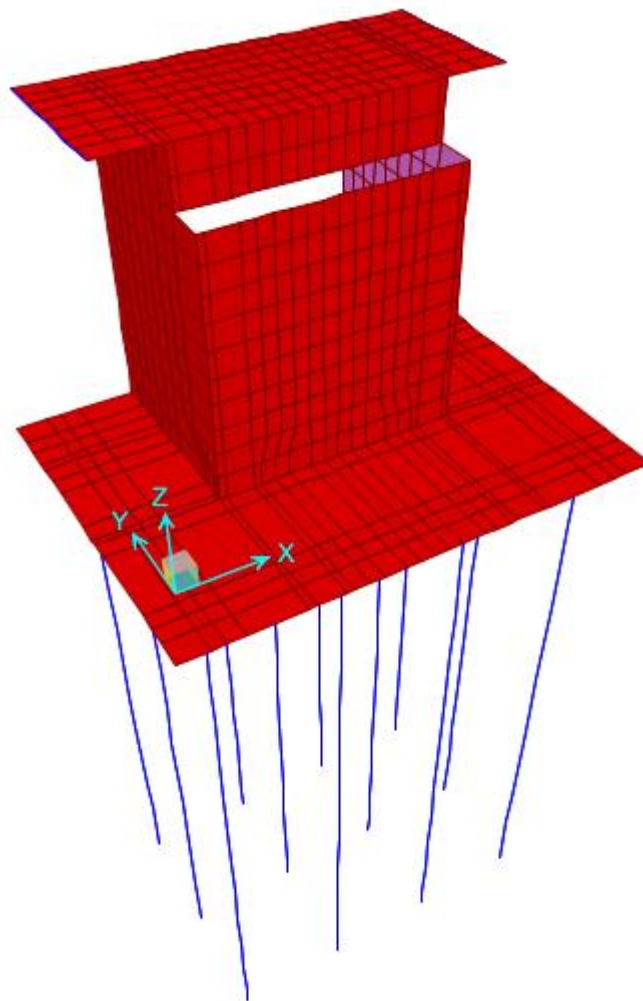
Modello 3D – Vista estrusa degli elementi
